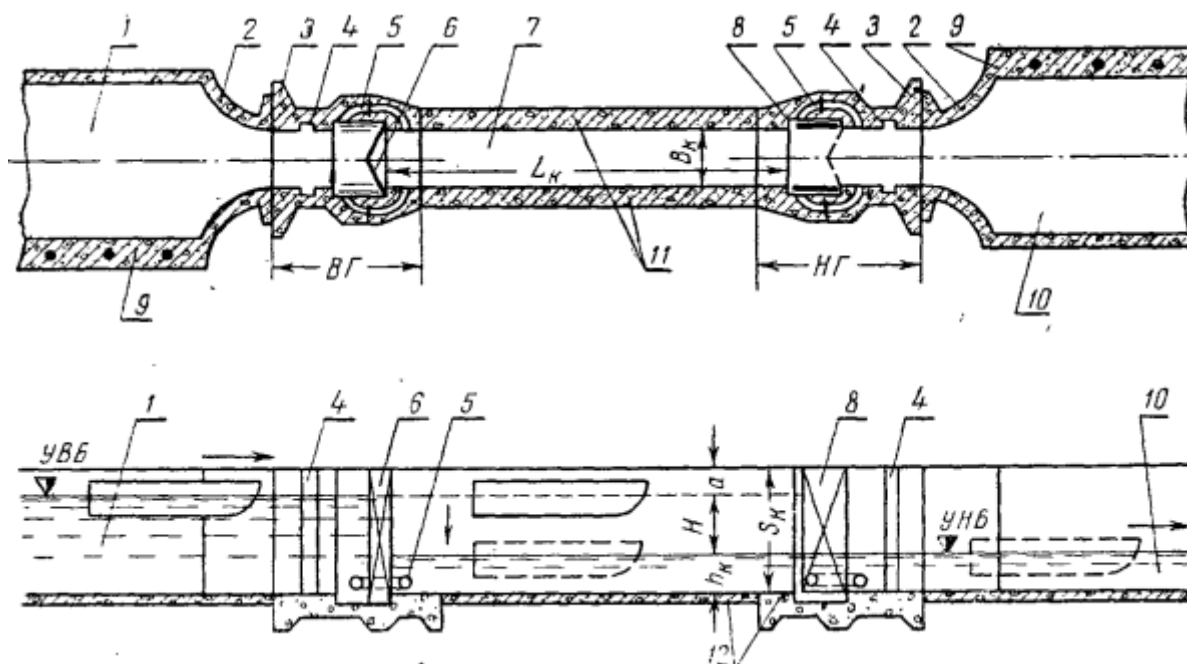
Общая схема однокамерного шлюза: 1 – верхний подходной канал; 2 – направляющие палы; 3 – обратные стены; 4 – пазы для шандор; 5 – водопроводные галереи с затворами; 6 – верхние ворота (закрыты); 7 – камера шлюза; 8 – нижние ворота (открыты); 9 – причальные стенки; 10 – нижний подходной канал; 11 – стенки камеры; 12 – дно камеры; ВГ – верхняя голова; НГ – нижняя голова; L_k – длина камеры; B_k – ширина камеры; H – напор шлюза; h_k – глубина на короле; a – запас высоты стен камеры
